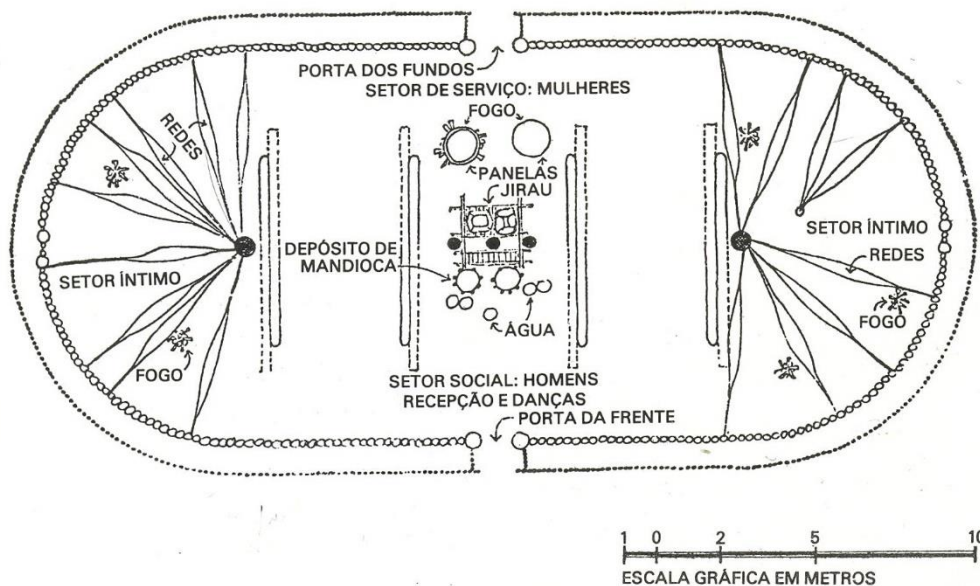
Planta baixa da casa Yawalapiti (SÁ apud NOVAES, 1983, p. 116)
